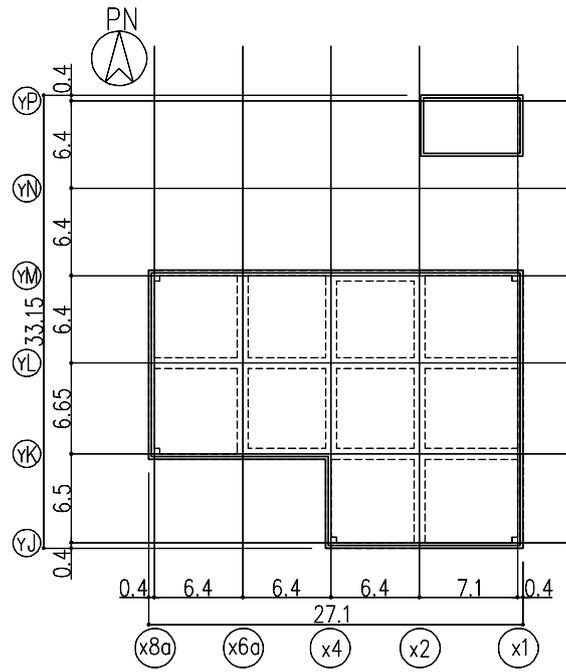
屋上階平面図 (G. L. +15.4) (单位: m)
